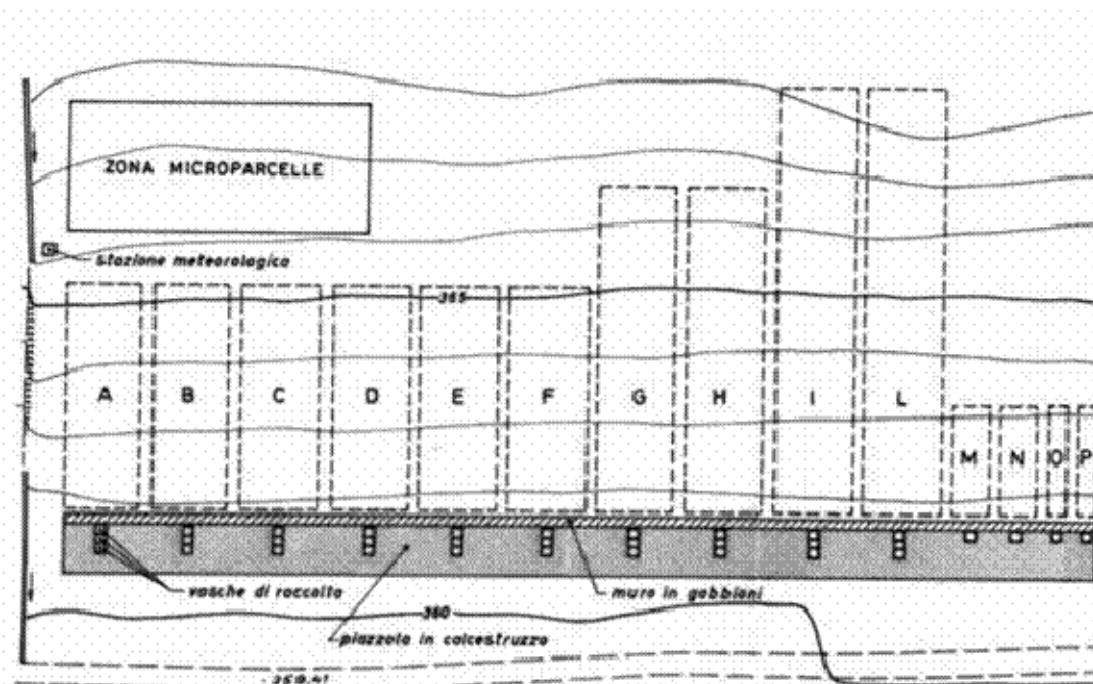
Pianta e vista dell'installazione sperimentale prima dell'esecuzione dei lavori.
